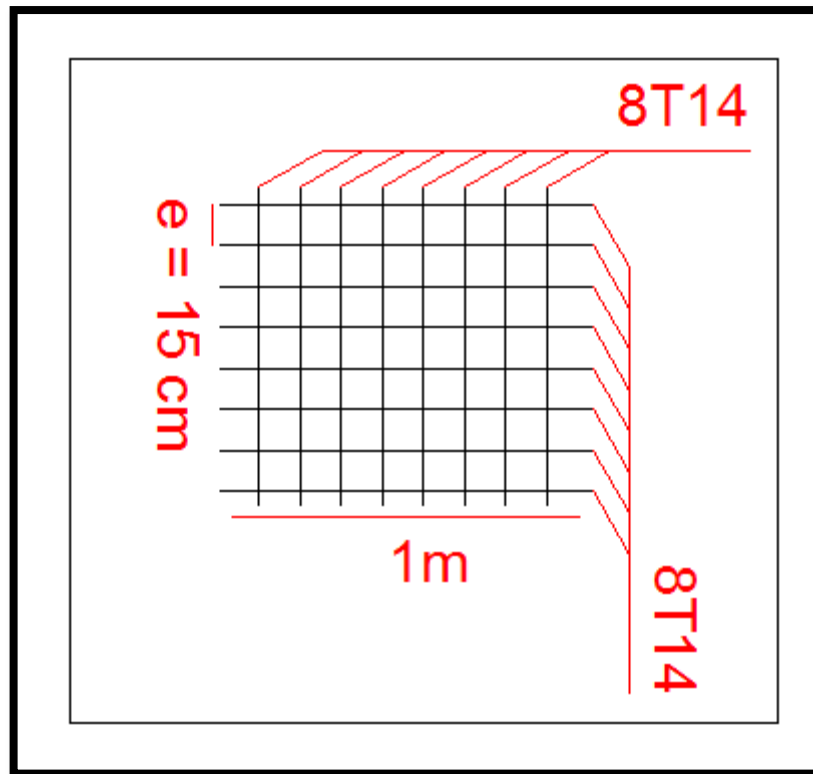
Schéma de Ferrailage du voile périphérique.
